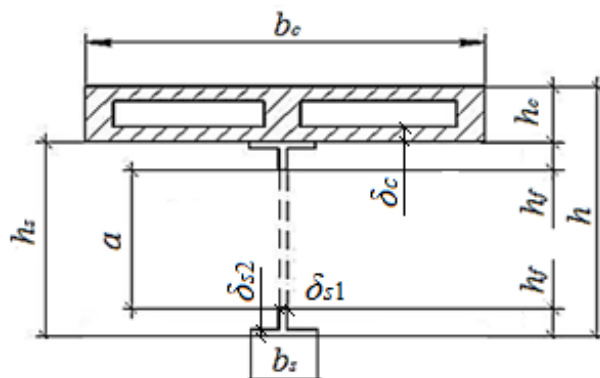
Поперечний переріз фрагмента прогонової будови
